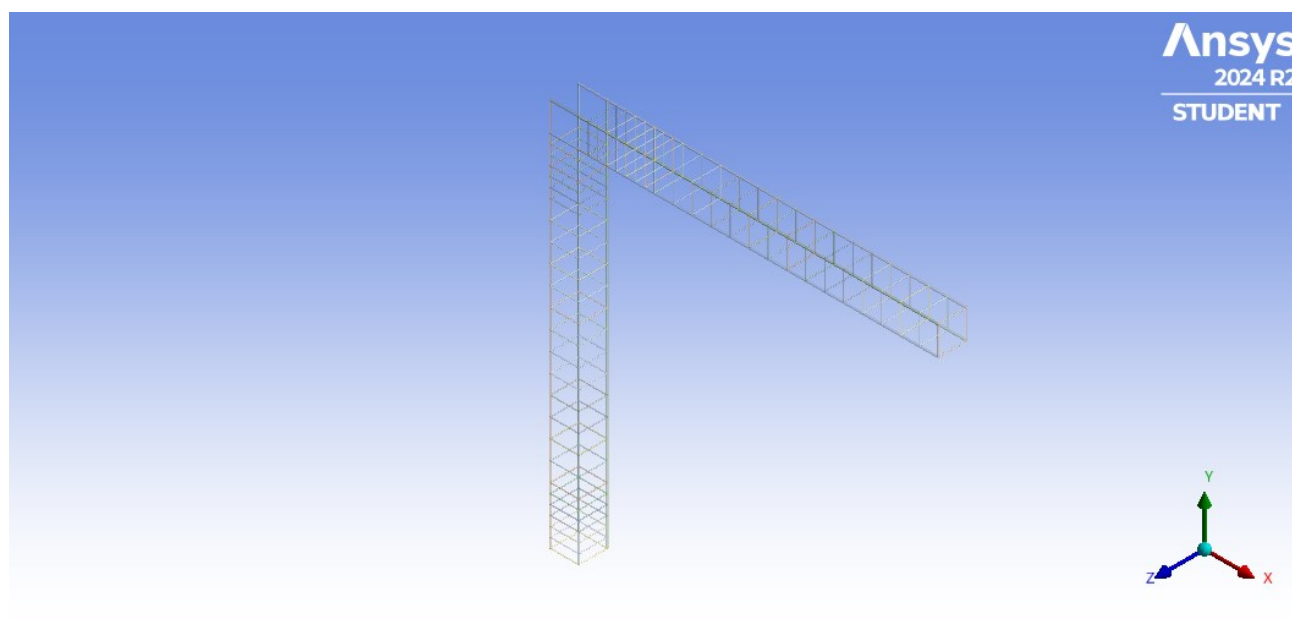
Vista assonometrica delle barre longitudinali e staffe con sezioni circolari assegnate
